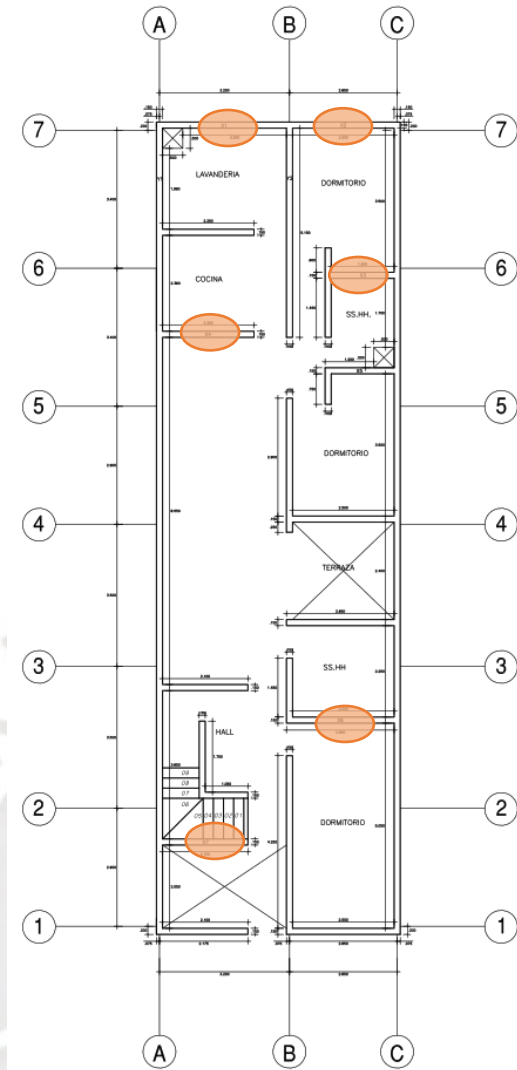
Plano de la primera planta de la vivienda indicando los muros a reforzar (Fuente: Propia)
